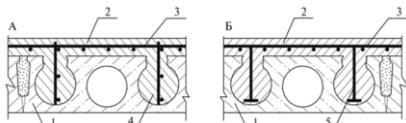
Усиление пустотной плиты перекрытия методом внутреннего армирования: А – гибкой арматурой; Б – жесткой арматурой, 1 — плита; 2 — бетон усиления; 3 — горизонтальное армирование усиления; 4 — вертикальные каркасы усиления; 5 — прокатные двутавровые балки
